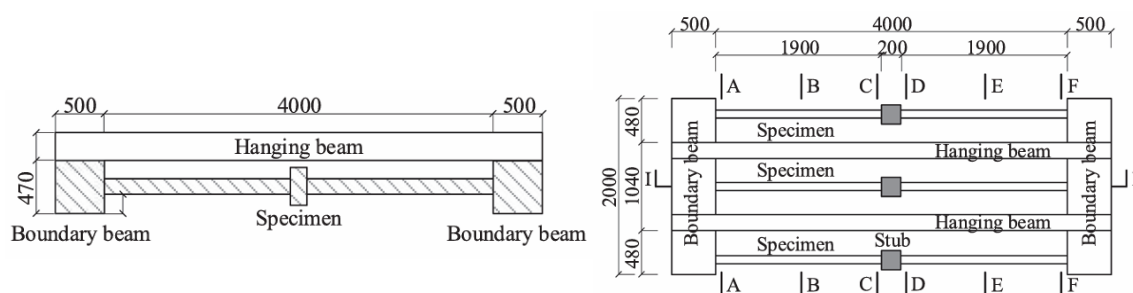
Sezione I-I e planimetria della struttura dell'esperimento di Zhao et al.
